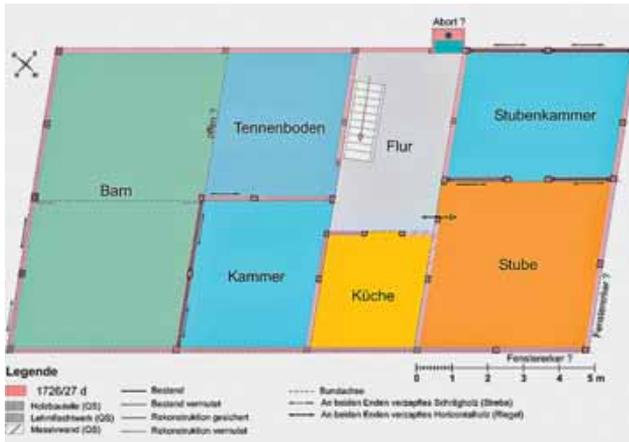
Reutlingen, Metzgerstraße 39: Rekonstruktion des ursprünglichen Grundrisses im Obergeschoss mit Barn und Tennenboden des Scheunenteils und dem zur Metzgerstraße hin gewandten Wohnteil.
